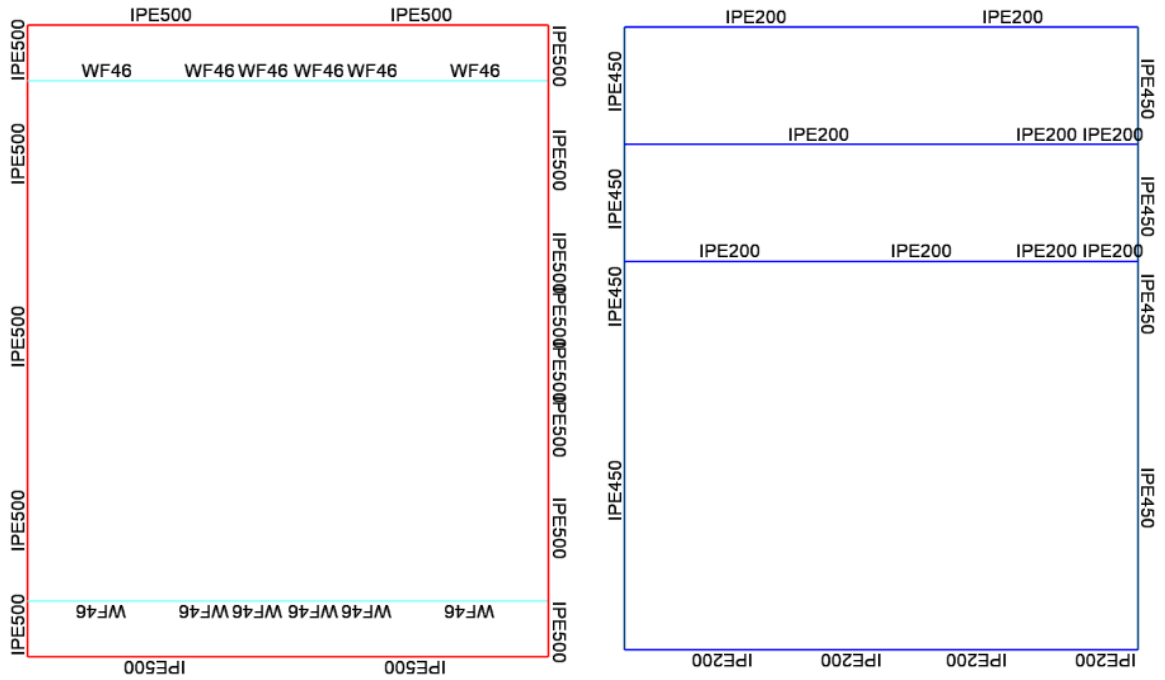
Planta Superior (izq.) y Planta Intermedia (der.)
